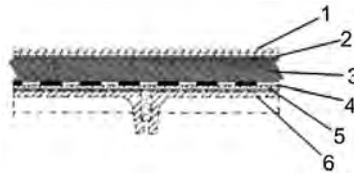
Неэксплуатируемые инверсионные кровли: 1 — пригрузочный слой из гравия; 2 — предохранительный (фильтрующий) слой — геотекстиль; 3 — ПЕНОПЛЭКС; 4 — гидроизоляция кровли рулонным материалом; 5 — уклонообразующий слой из легкого бетона или цементно-песчаного раствора; 6 — железобетонная плита перекрытия
